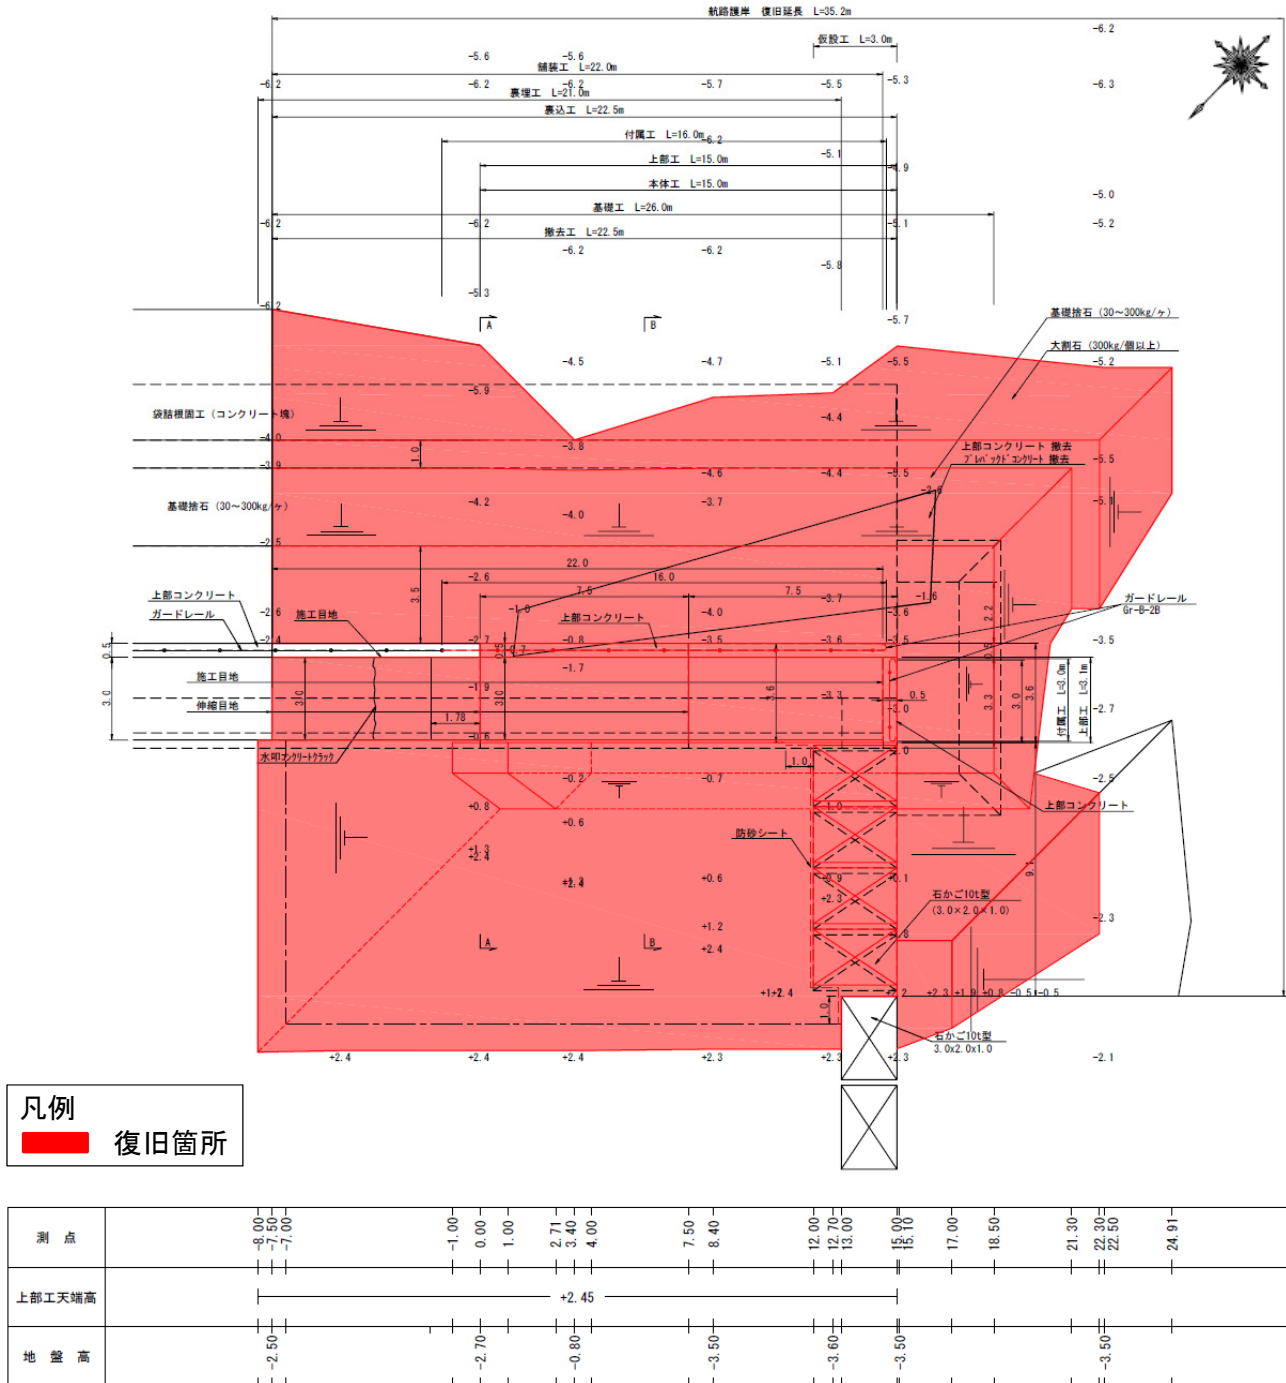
No.3 航路護岸の平面図（復旧後）
